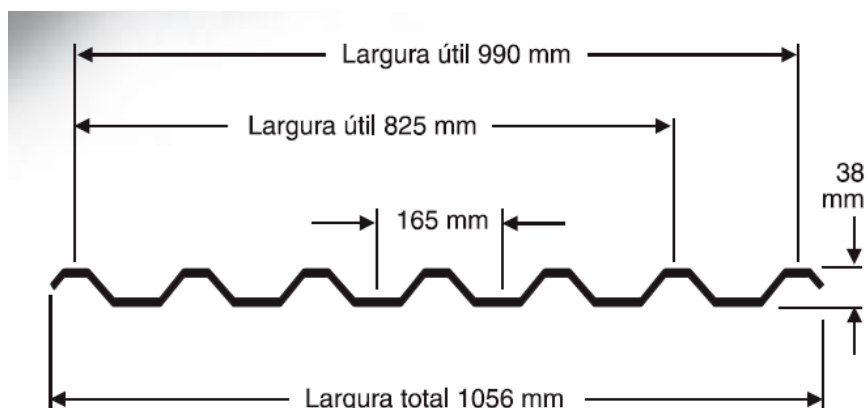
Perfil da Telha Votoral® Trapezoidal AF38/990
